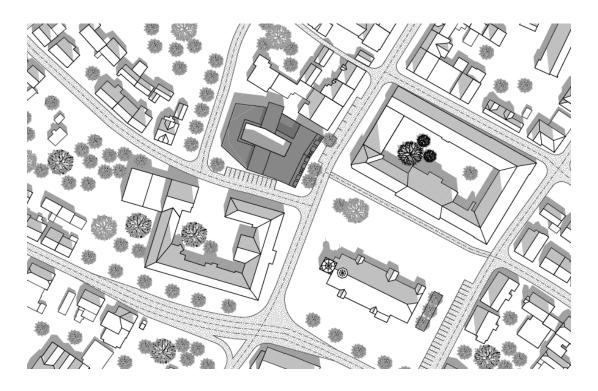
Lageplan des geplanten Objektes (Mars-Architekten, 2020)
